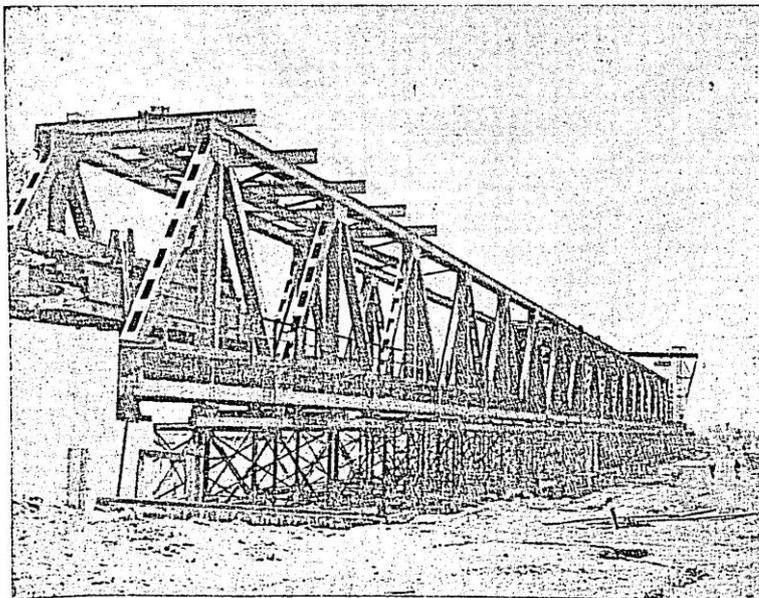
Montagem da superestrutura da ponte do Rio Grande, vista de um dos encontros.
